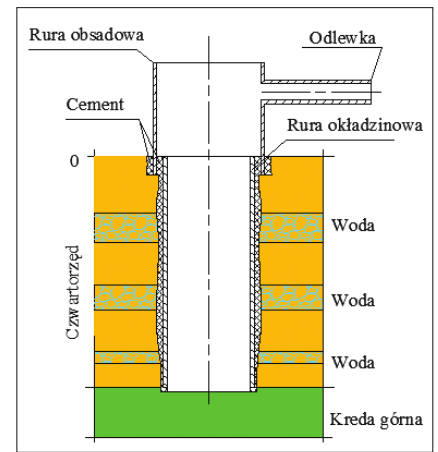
Proces cementowania rur okładzinowych w otworach geotermalnych
